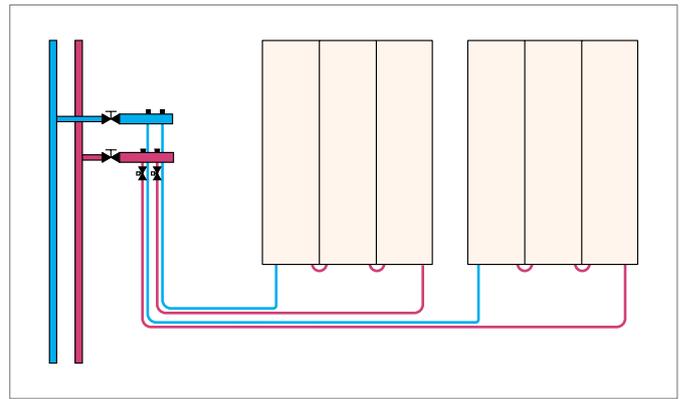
Rappresentazione schematica del collegamento in serie
